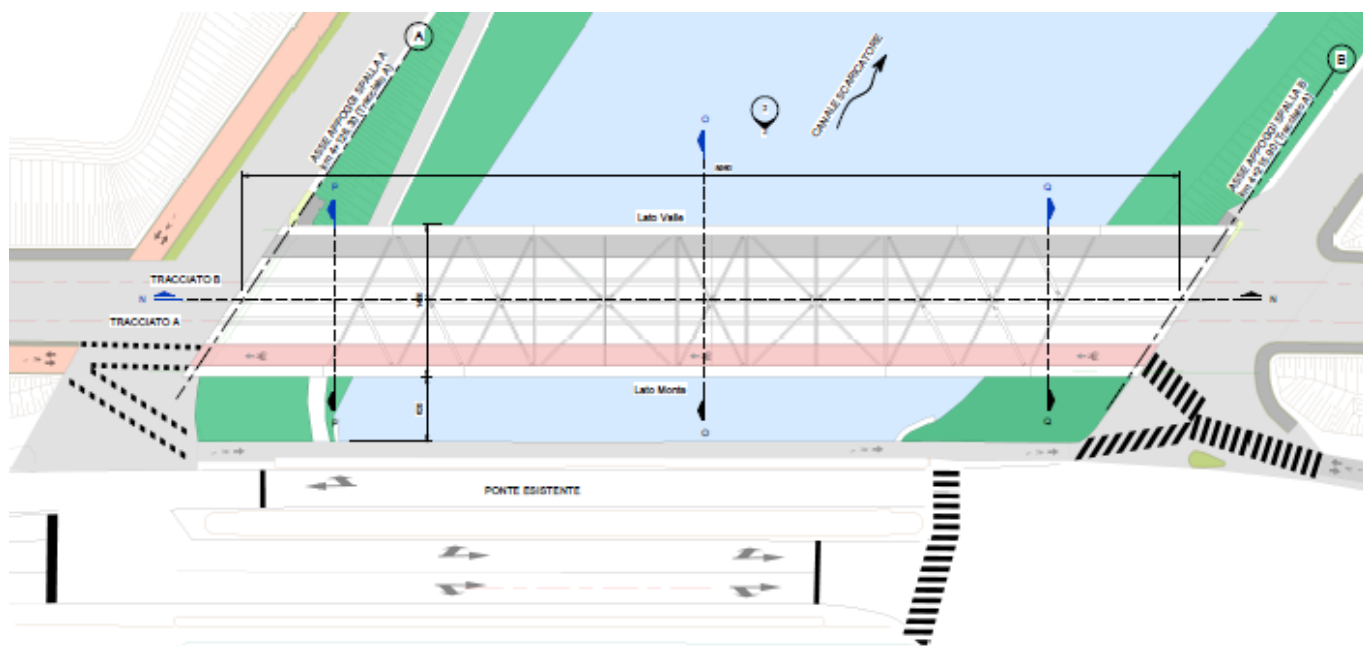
Planimetria del nuovo ponte sul canale Scaricatore
